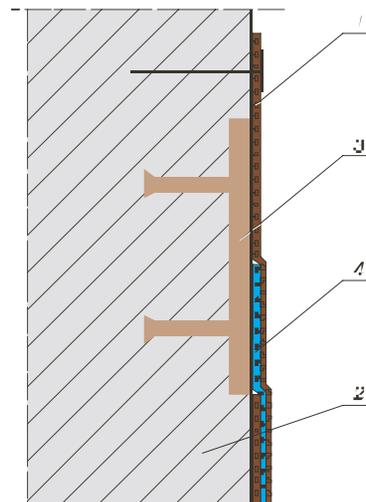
Крепление материалов «Trocac» к основанию с помощью специального соединительного ПВХ-профиля: 1 – защитная мембрана «Trocac TS» или геотекстиль, прикрепленный механически; 2 – конструкция стены; 3 – соединительный ПВХ-профиль; 4 – гидроизоляционная мембрана «Trocac»
